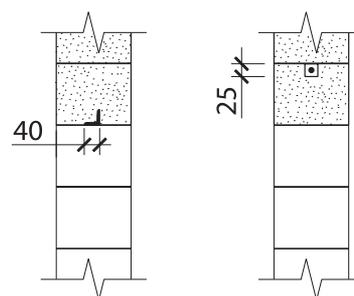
Примеры рядовых перемычек из газобетонных блоков
